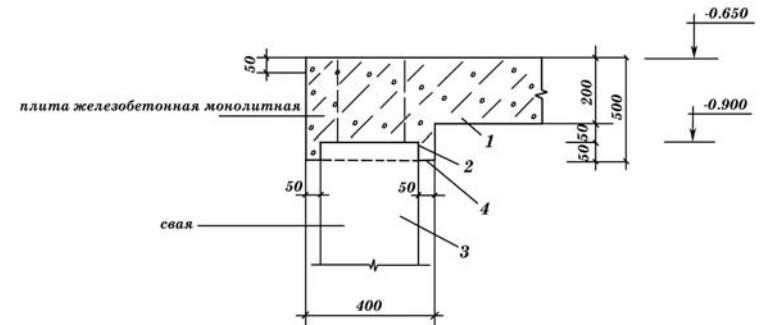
Разрез узла углового крепления бетонной плиты к основанию грунта опорной свайей:
